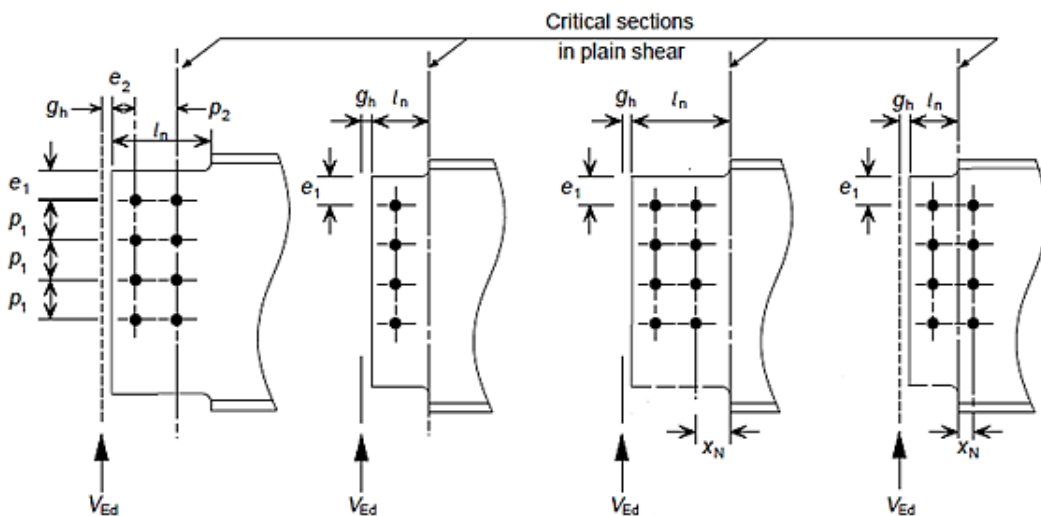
Possíveis localizações da secção crítica por plano de corte da região entalhada da viga, adaptado de (SCI/BCSA Connections Group, 2011).
